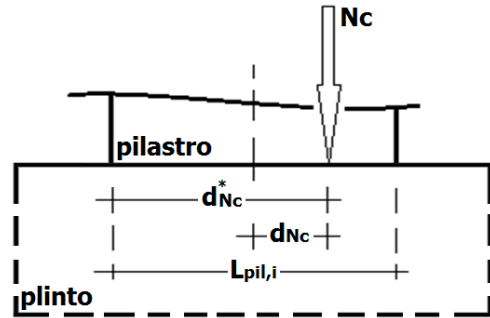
posizione della risultante degli sforzi di compressione ( $N_c$ ) alla base del pilastro, nella direzione i-esima
